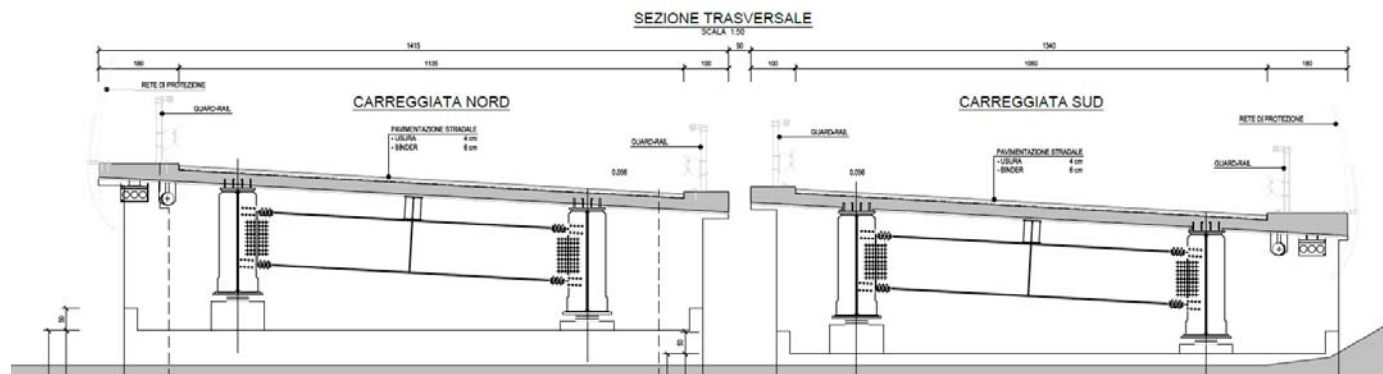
Ponte Torrente Gravina: Sezione dell'impalcato
